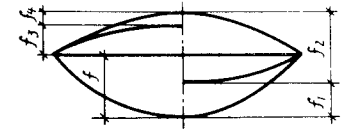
К определению прогиба предварительно напряженной железобетонной балки, работающей без трещин в растянутой зоне
